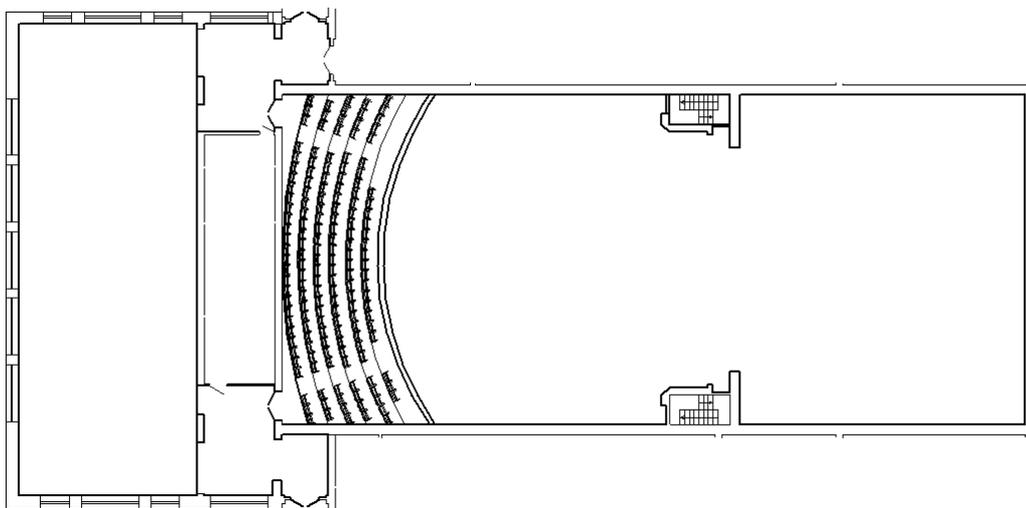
Фрагмент поэтажных планов: балкон зрительного зала, сцена, фойе 3-го этажа
